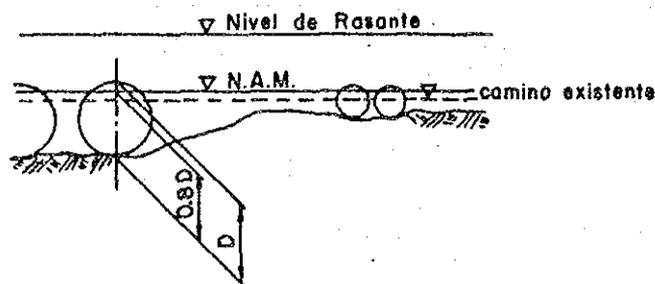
Relación esquemática del diámetro de alcantarillas, configuración de terreno y nivel de aguas máximas.
